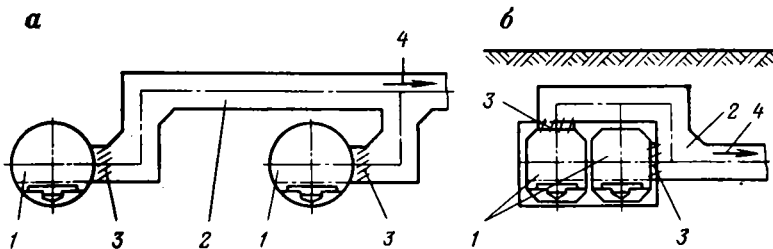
VIII. Схема примыкания вентиляционных тоннелей сверху к путевым перегонным тоннелям:
